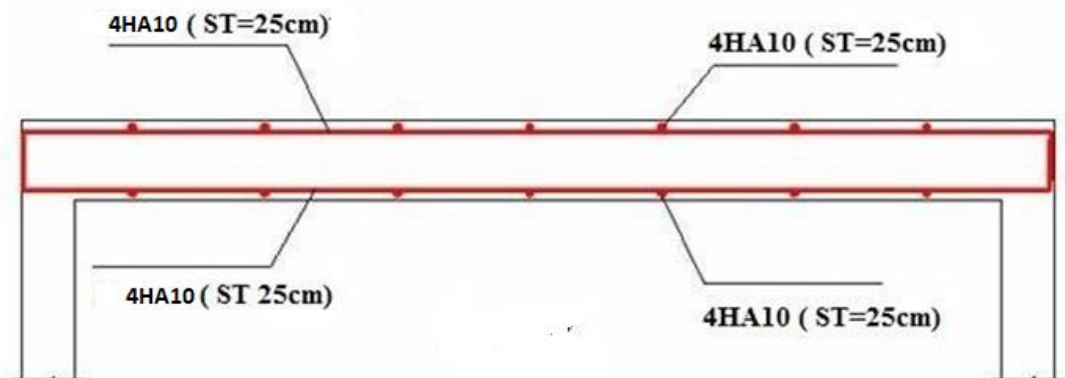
plan de ferrailage de la salle machine suivant y-y.
